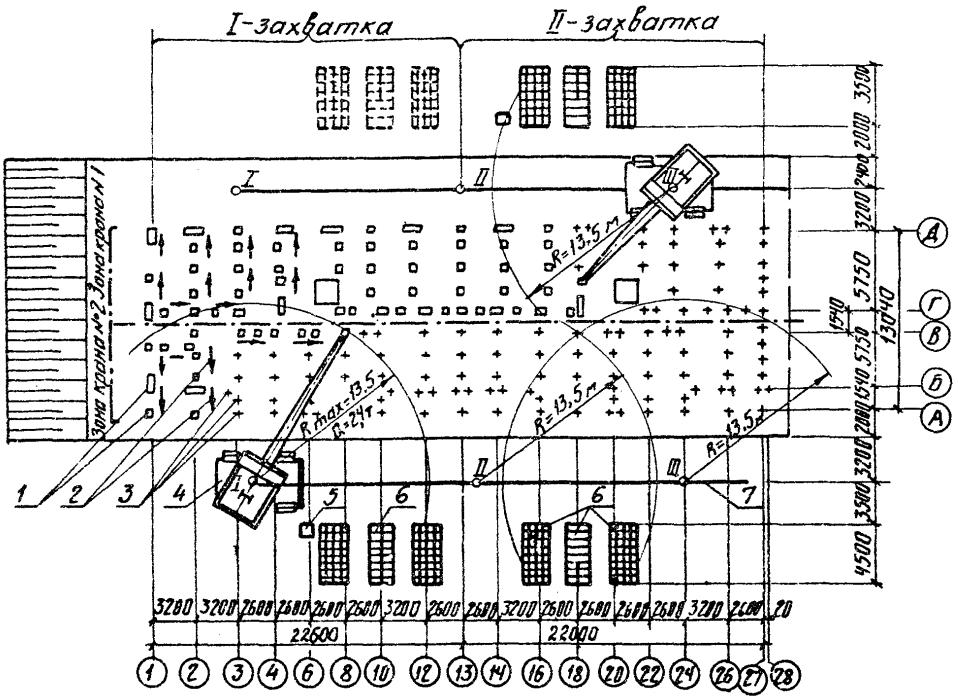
Схема организации работ по монтажу оголовков: 1-смонтированные оголовки; 2-направление монтажа; 3-забитые сваи; 4-пневмоколесный кран К-161; 5-ящики для приема бетона; 6-штабели оголовков; 7-ось движения крана; I, II, III - стоянки крана
